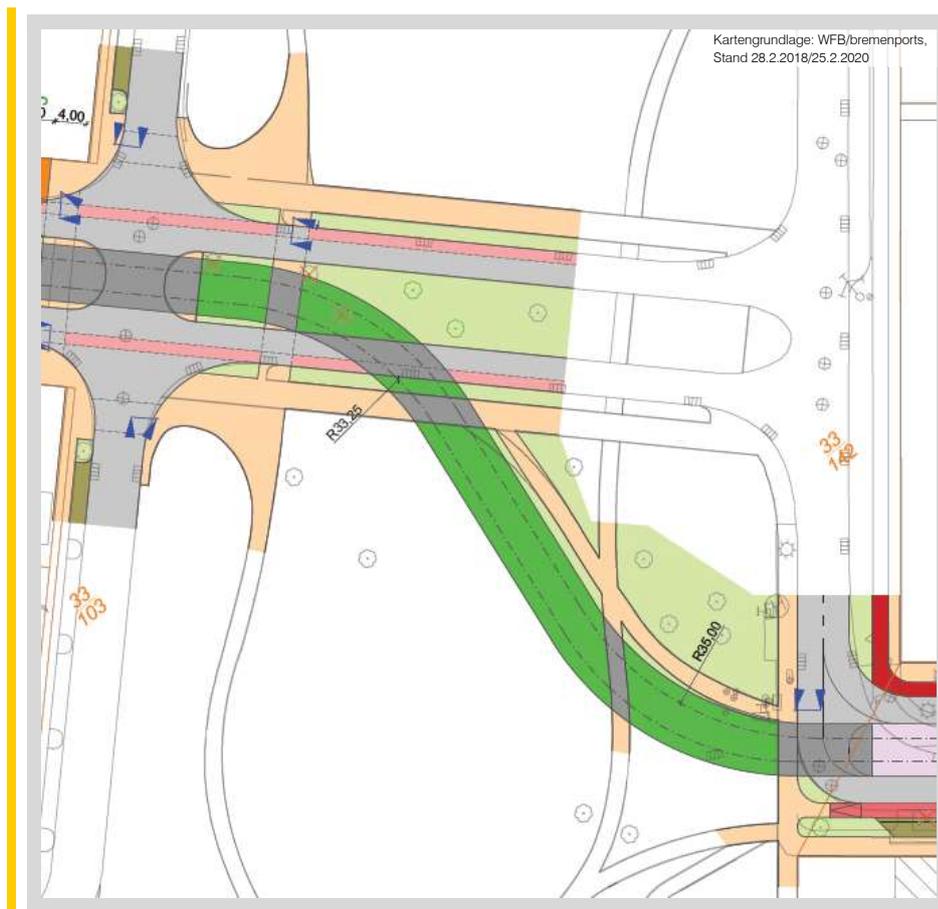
Ausschnitt Lageplan Querung Überseepark in K.-Johnsen-Boulevard
